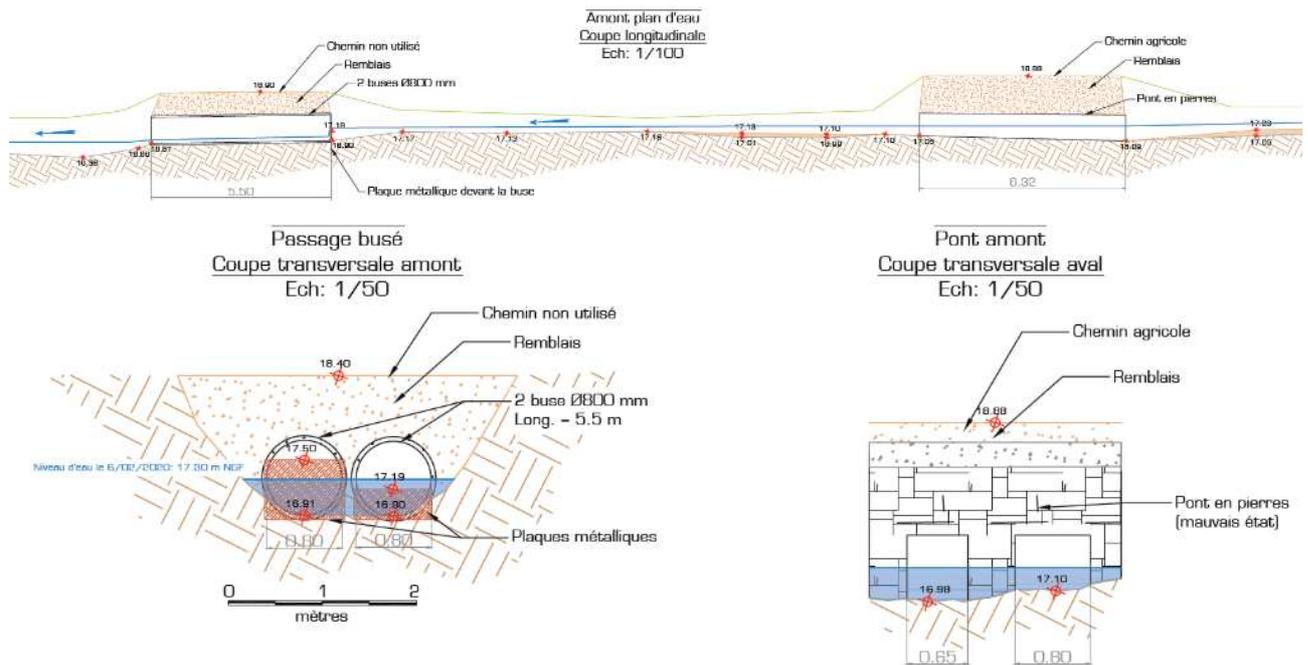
Vues des ouvrages de franchissement en amont du plan d'eau
